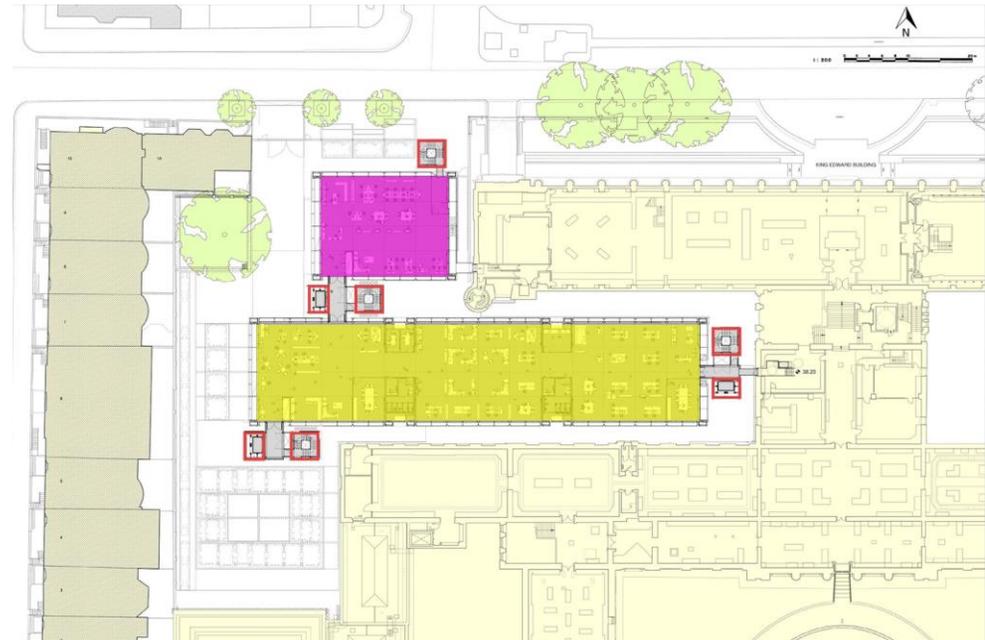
Zonificación de la planta del nivel 01. *Stirk, R. (2014).
